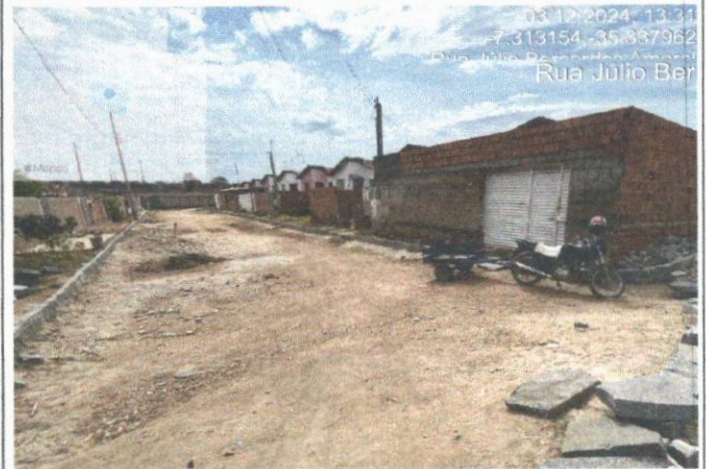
EXECUÇÃO DO MEIO-FIO
